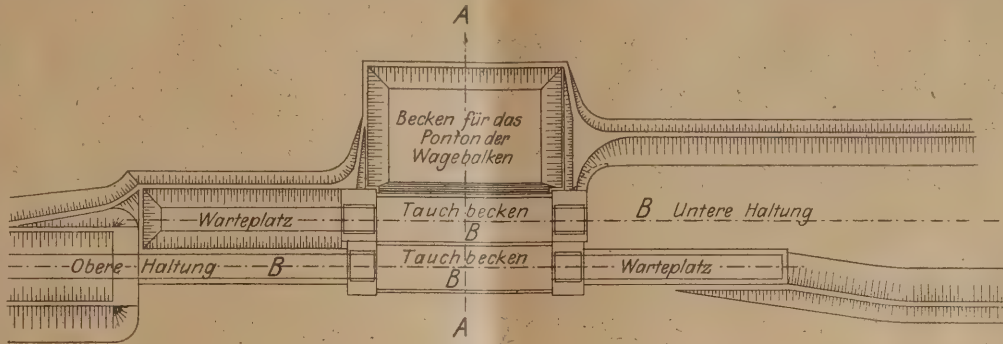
Lageplan eines senkrechten MAN-Hebewerks mit Tauchtrog.
